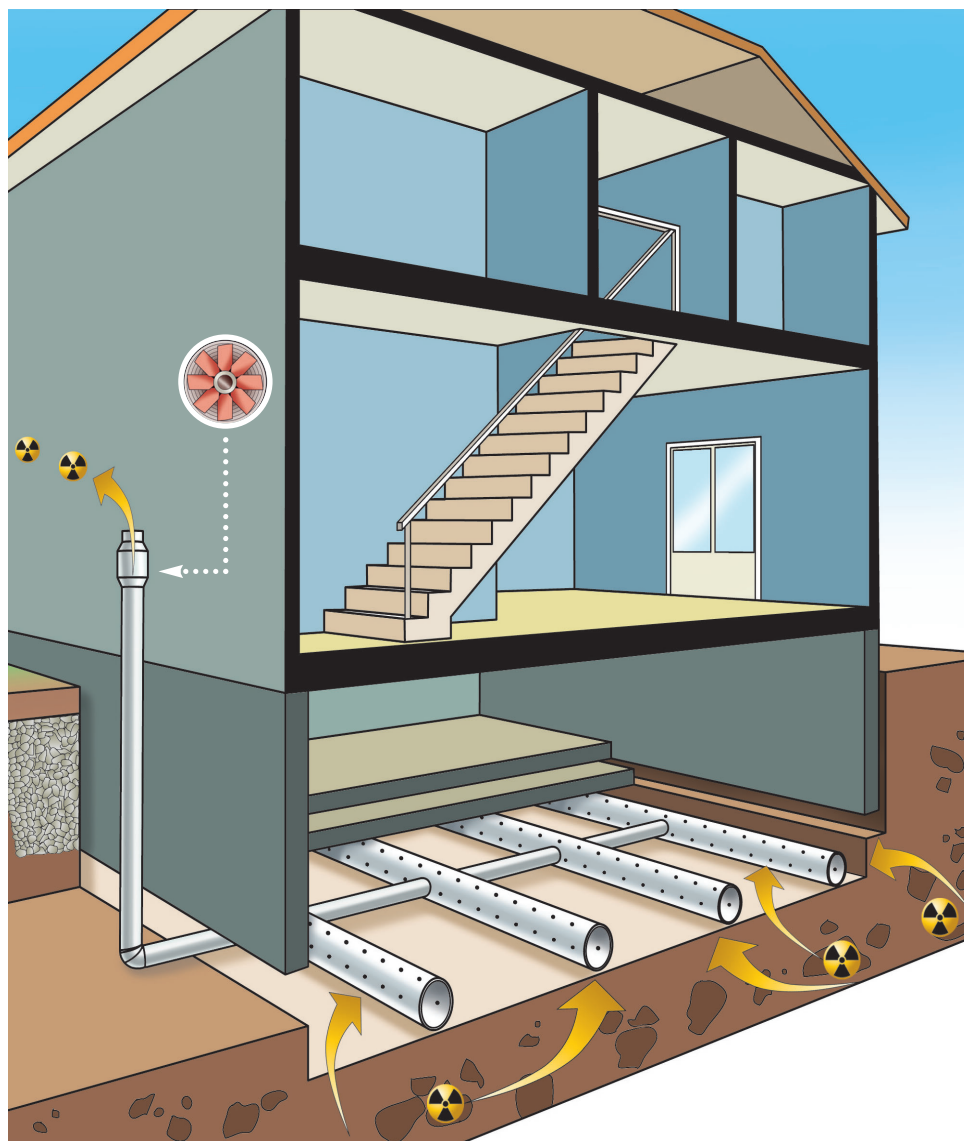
Casa con fondazione a platea impermeabilizzata all'ingresso del radon. Nell'esempio riportato all'impermeabilizzazione è stato abbinato un sistema di drenaggio (collettori posti sotto lo strato di materiale impermeabile).
